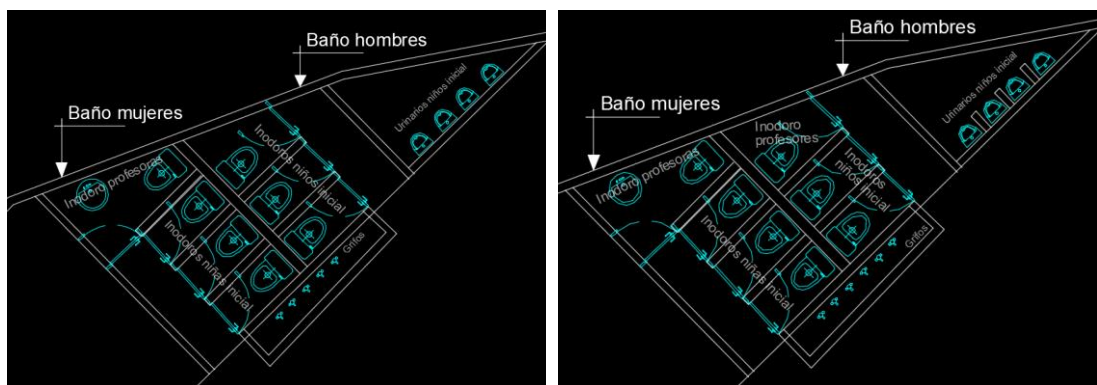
Plano arquitectónico actual y futuro del bloque 1. Fuente: autoría propia
